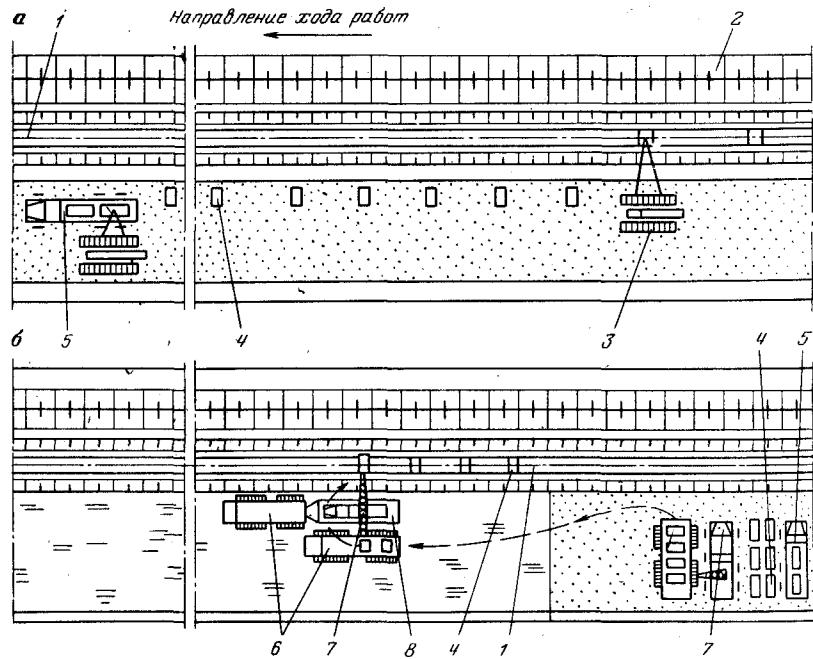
Схема организации работ по балластировке трубопровода утяжеляющими железобетонными грузами:
